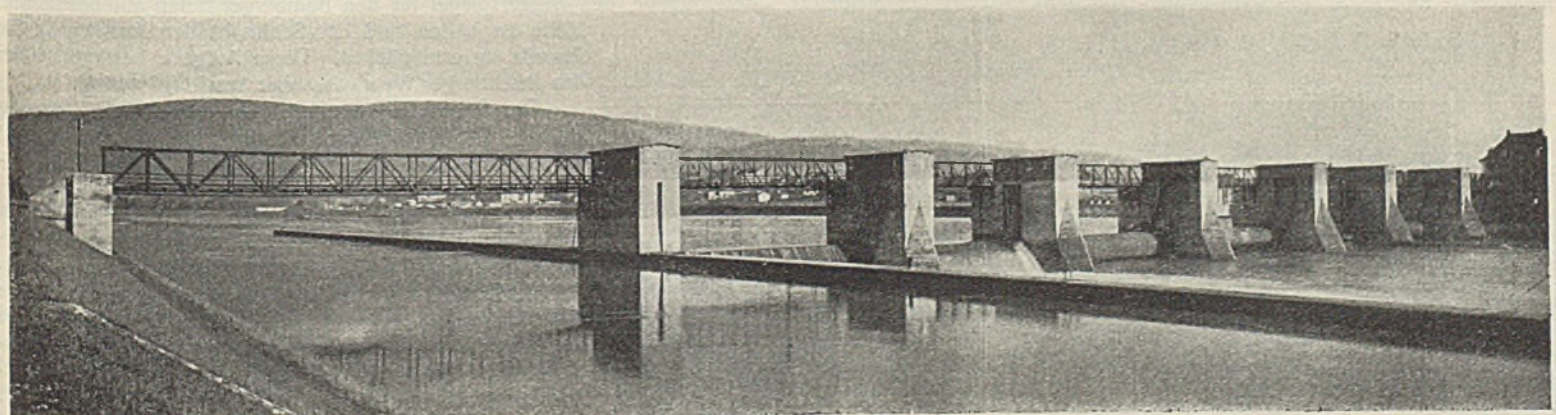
Staustufe Wieblingen, Wehranlage mit Seitenkanal.
